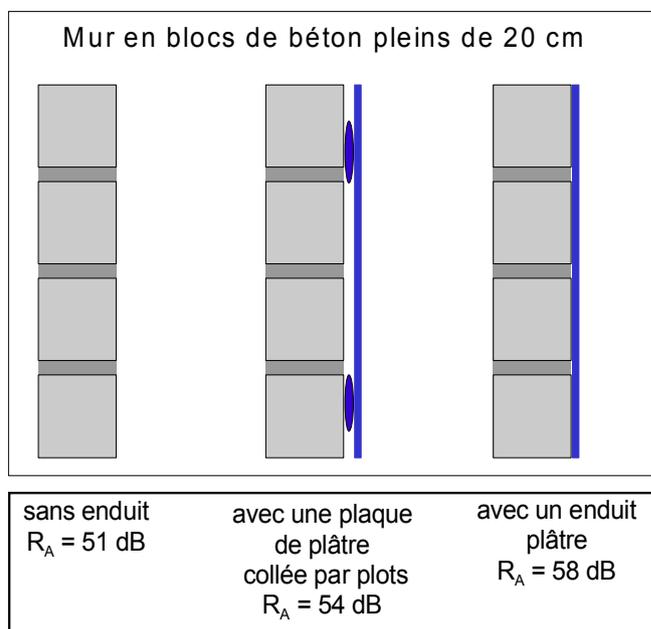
Exemple d'une paroi en blocs pleins en béton de 20 cm d'épaisseur :
